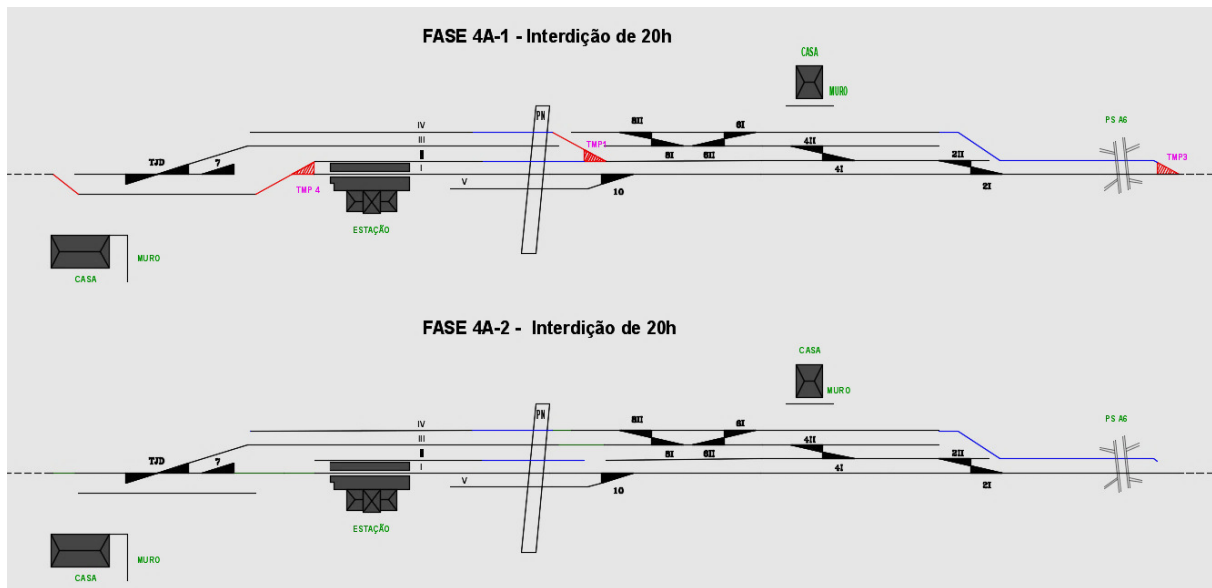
Fase 4A – Levantamento AMV TMP2, TMP3 e TMP4 e assentamento das ligações
